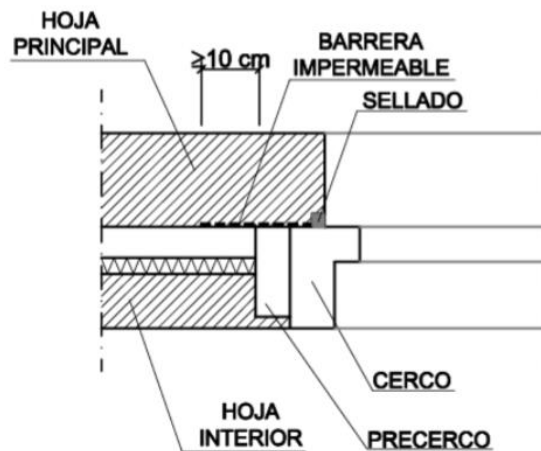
Ejemplo de encuentro de la fachada con la carpintería CTE-DB-HS1
